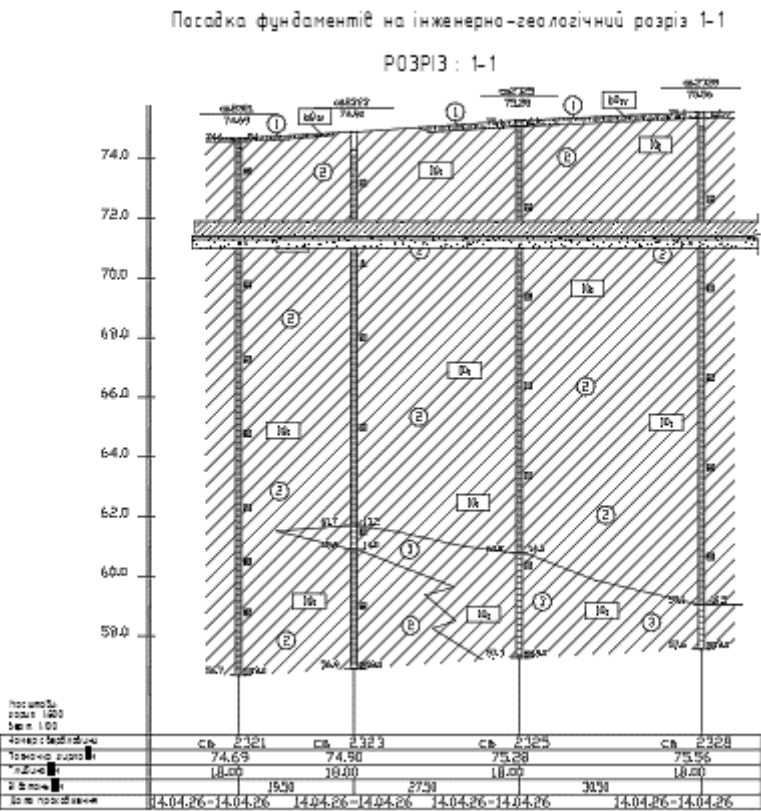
Посадка фундаментів будівлі дитячого садочка на інженерно-геологічний переріз
